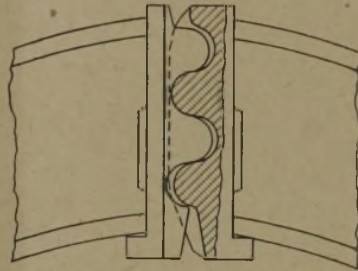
Eisenausbau mit Reckerschem Stahlgelenk.
